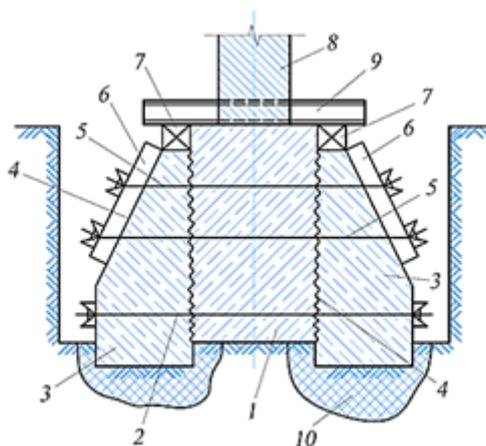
Усиление монолитного ленточного фундамента уширением основания с использованием обойм и обжатием грунта: 1 – фундамент; 2 – фиксированная затяжка; 3 – блоки обоймы; 4 – антифрикционное покрытие; 5 – тяжи; 6 – прижимной щит; 7 – клинья; 8 – стена здания; 9 – поперечная балка; 10 – обжатое основание
